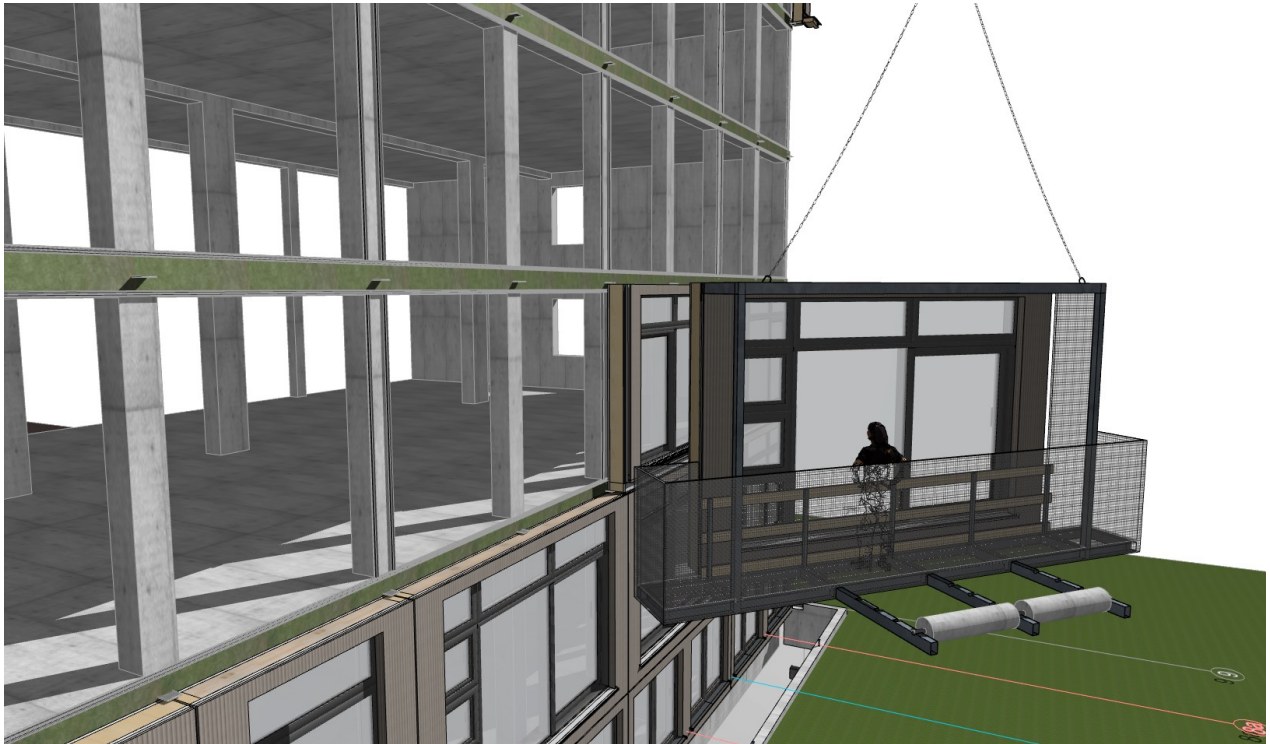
/ Aw 1a - Montage der Fassadenelemente mittels Montage- und Serviceplattform
